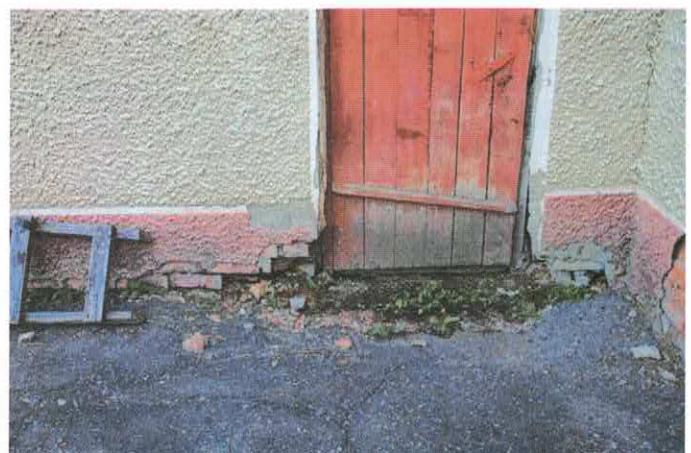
,8.2.6 Разрушение штукатурного слоя и кладки стен одноэтажного пристроя
